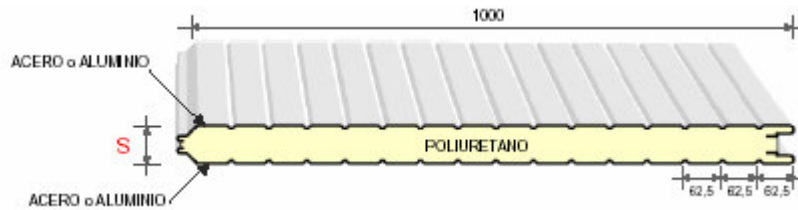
Panel para muro MONOWALL 1000/B¹
